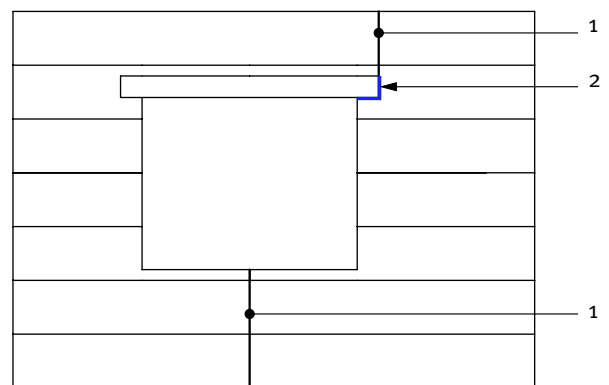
Voorbeeld van een uitzettingsanker in metselwerk uit cellenbeton.
